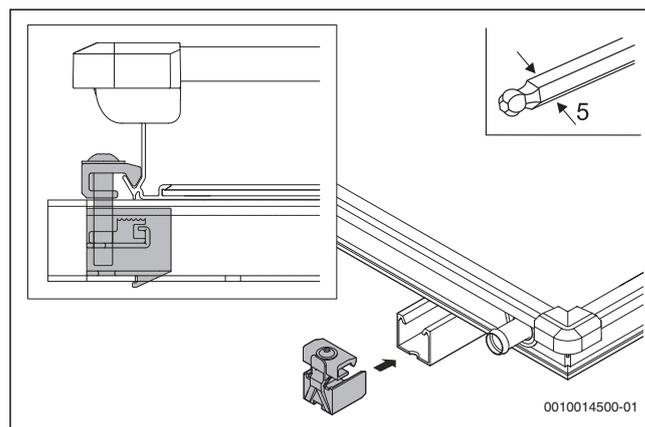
Montare i terminali di fissaggio sul lato sinistro
